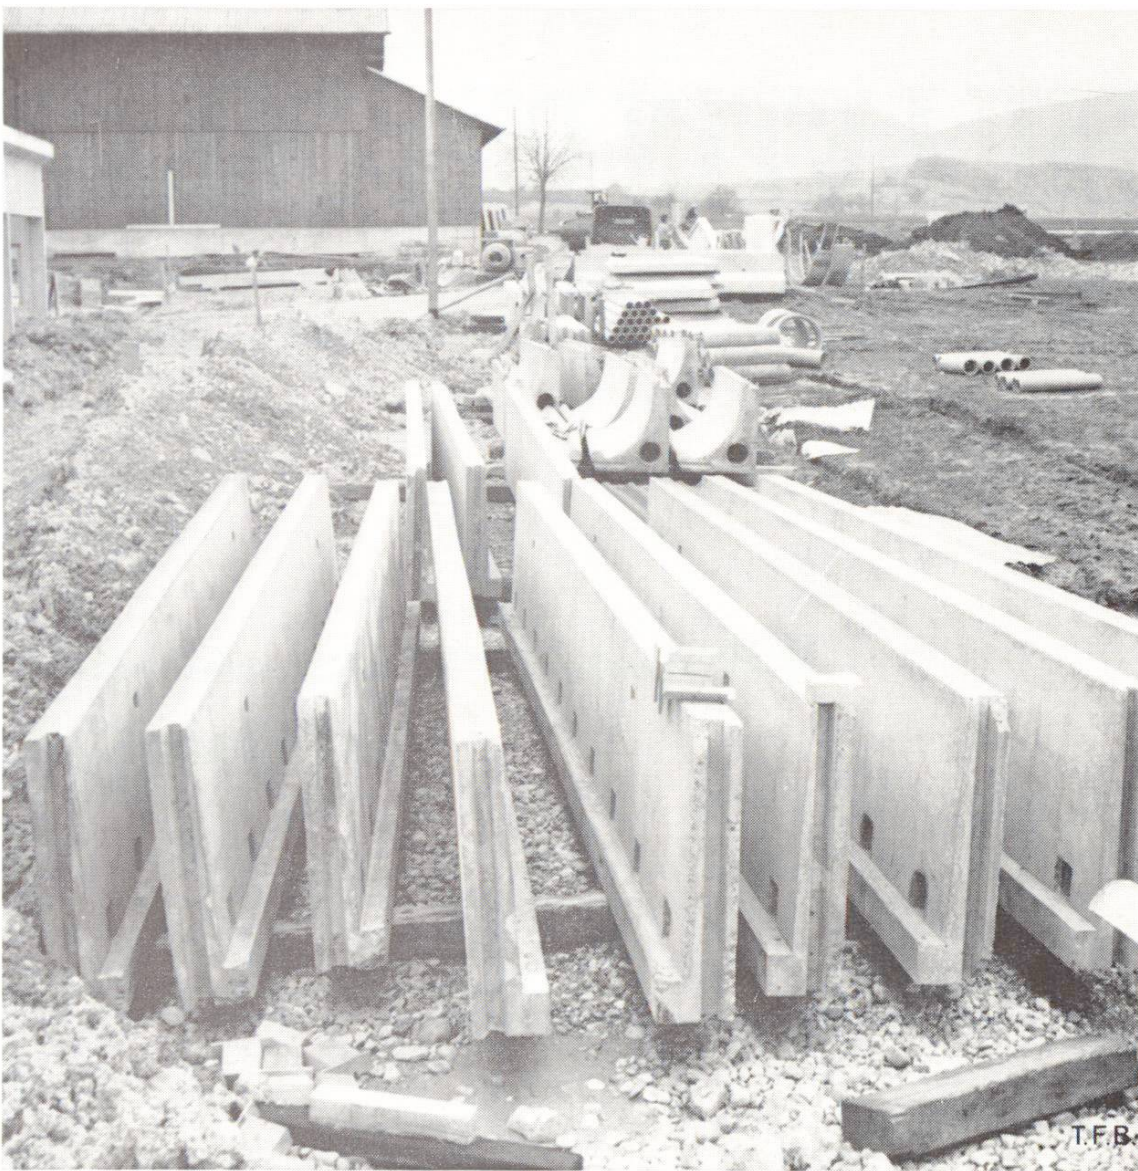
Divers éléments de construction en stock. Au premier plan, dalles pour rigoles à fumier; en arrière, crèches.
